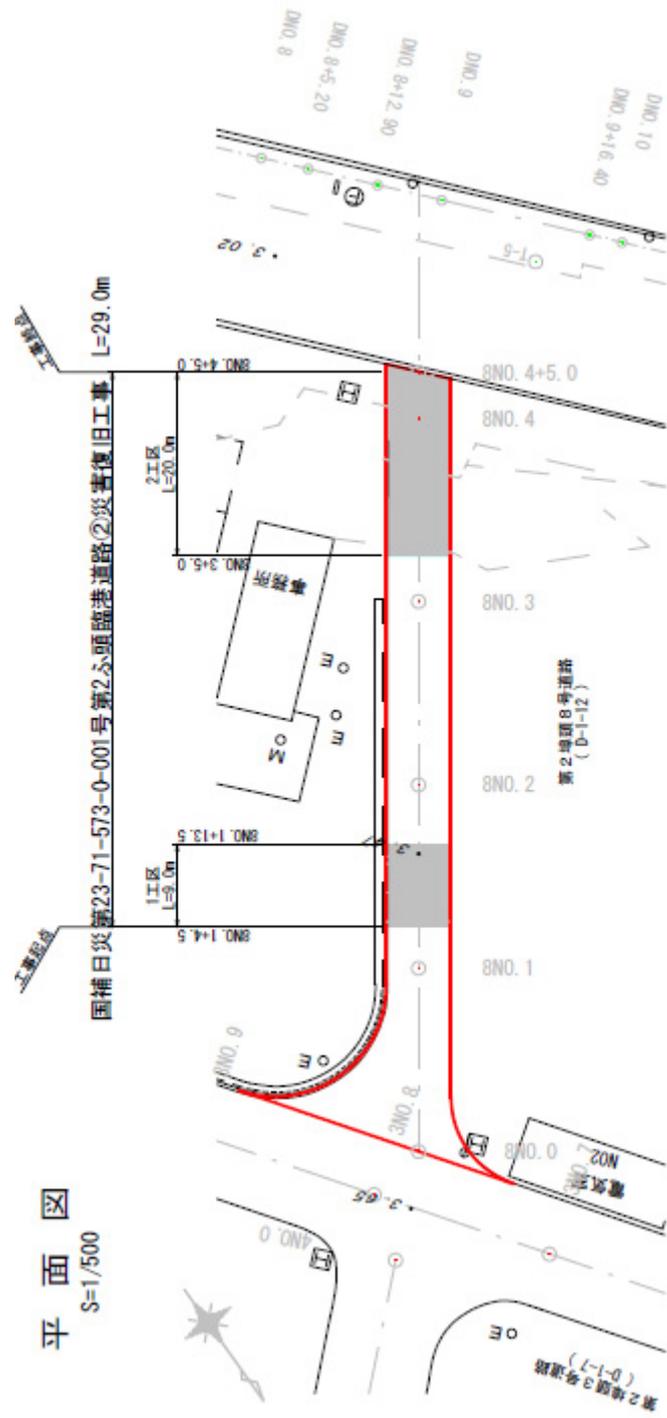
328 No.4 日立港区_第2埠頭8号道路の平面図 (復旧後)
